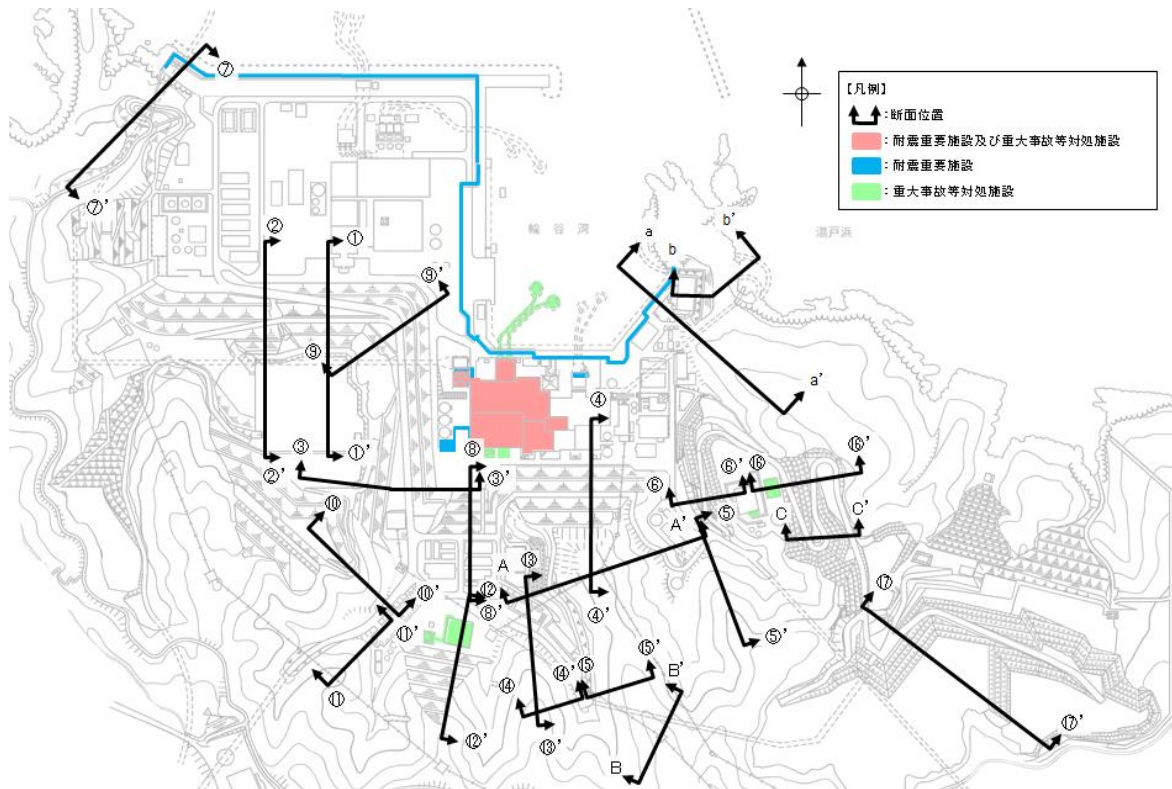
保管場所等に影響するおそれのある斜面の平面位置図
